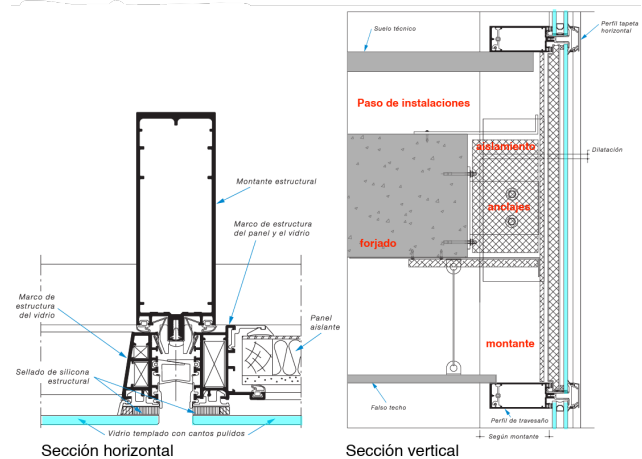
Cerramientos Ligetos. Muro Cortina.
